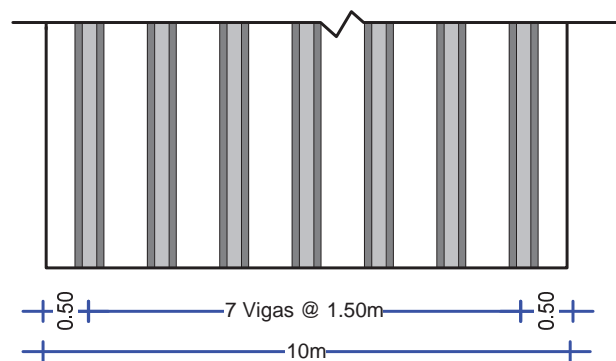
Distribución de vigas AASHTO sección transversal (vista en planta).
